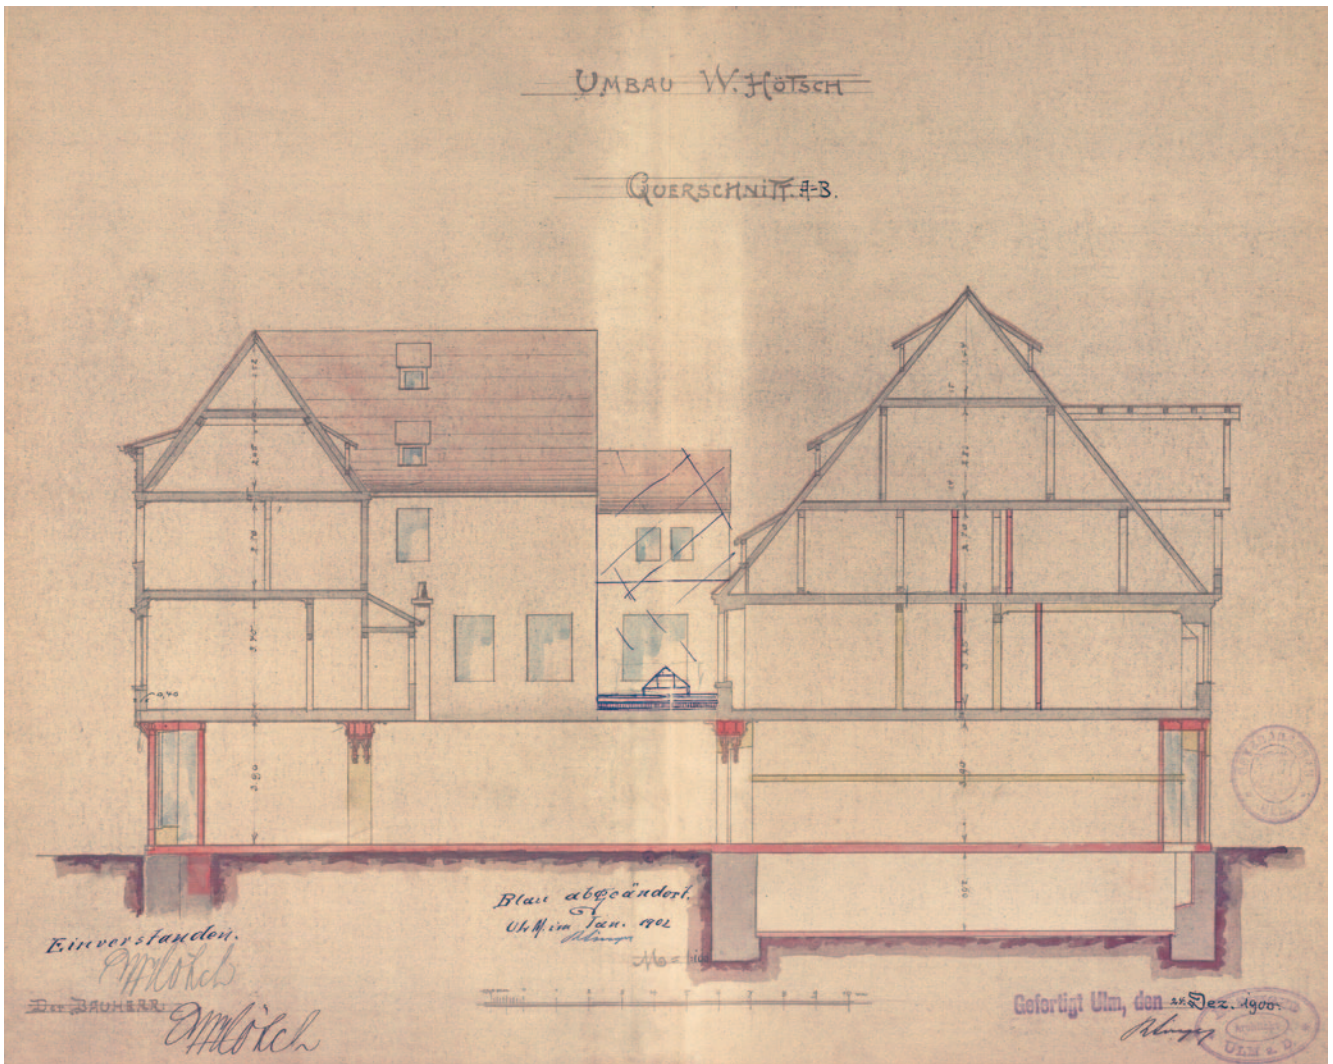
Gebäude Lange Straße 16 (A 261), Flügel (A 261 a) und Hinterhaus (A 261 b), Querschnittplan zur Umbaumaßnahme, Baugesuch 1901, 2. Fertigung. Hier wie im Grundrissplan (s. Abb. 100) deutliche Größenunterschiede bei den Gebäuden, wobei das Steinhaus in der Taubengasse als das ältere erscheint, trotz des stehenden Dachstuhls gegenüber dem liegenden Dachstuhl des Vorderhauses.
